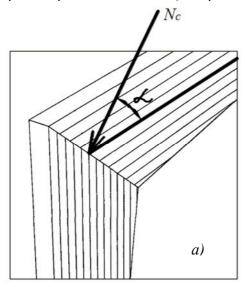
Клееная заготовка для изготовления стойки и ригеля рамы
